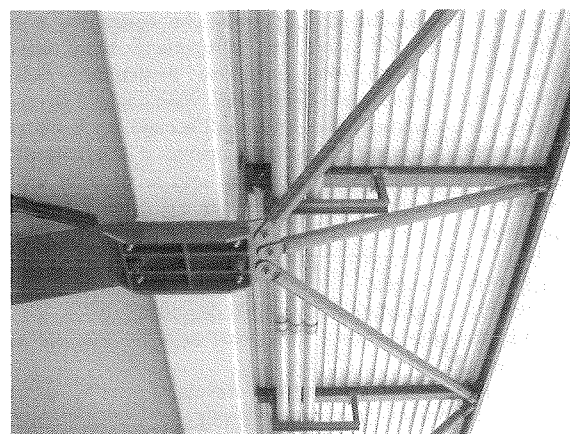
particolare attacco nuovo traverso - sbalzo
